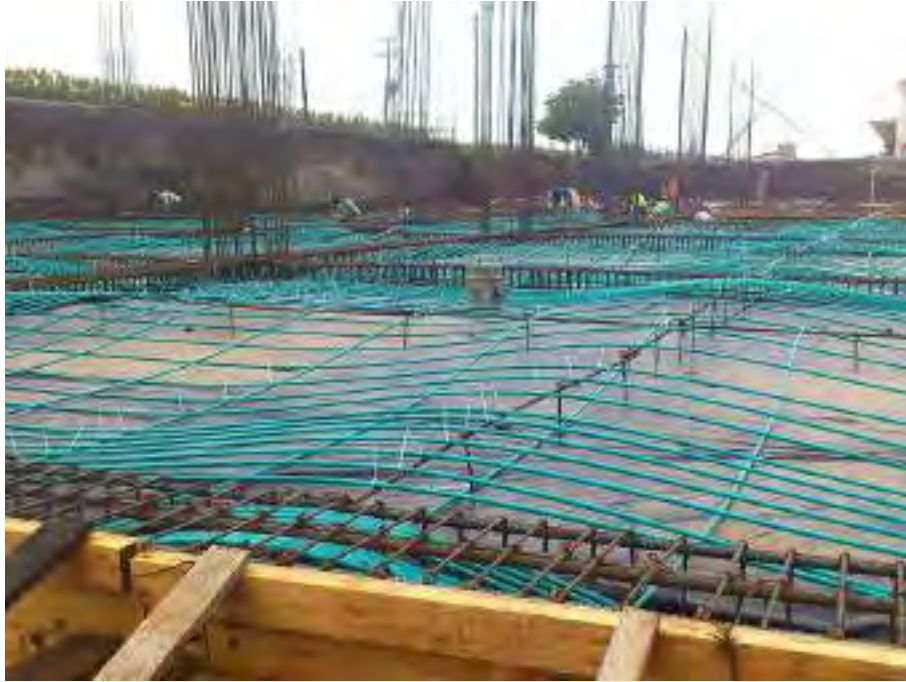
Losa postensada (fuente: Presforzados & mallas)
